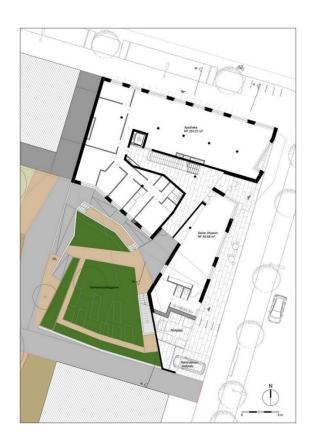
Grundriss EG, POS Architecture<sup>171</sup>
